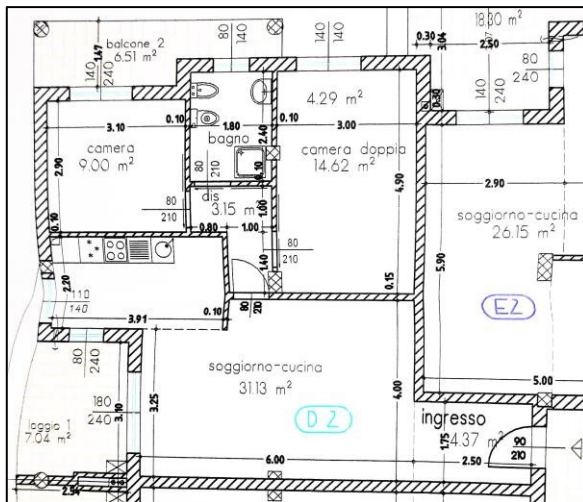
Planimetria allegata a DIA del 26.11.2007
